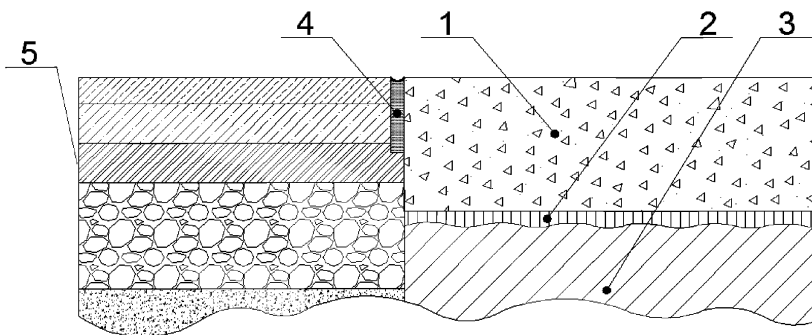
Схема сопряжения асфальтобетонного покрытия с слоем усиления из цементобетона:
